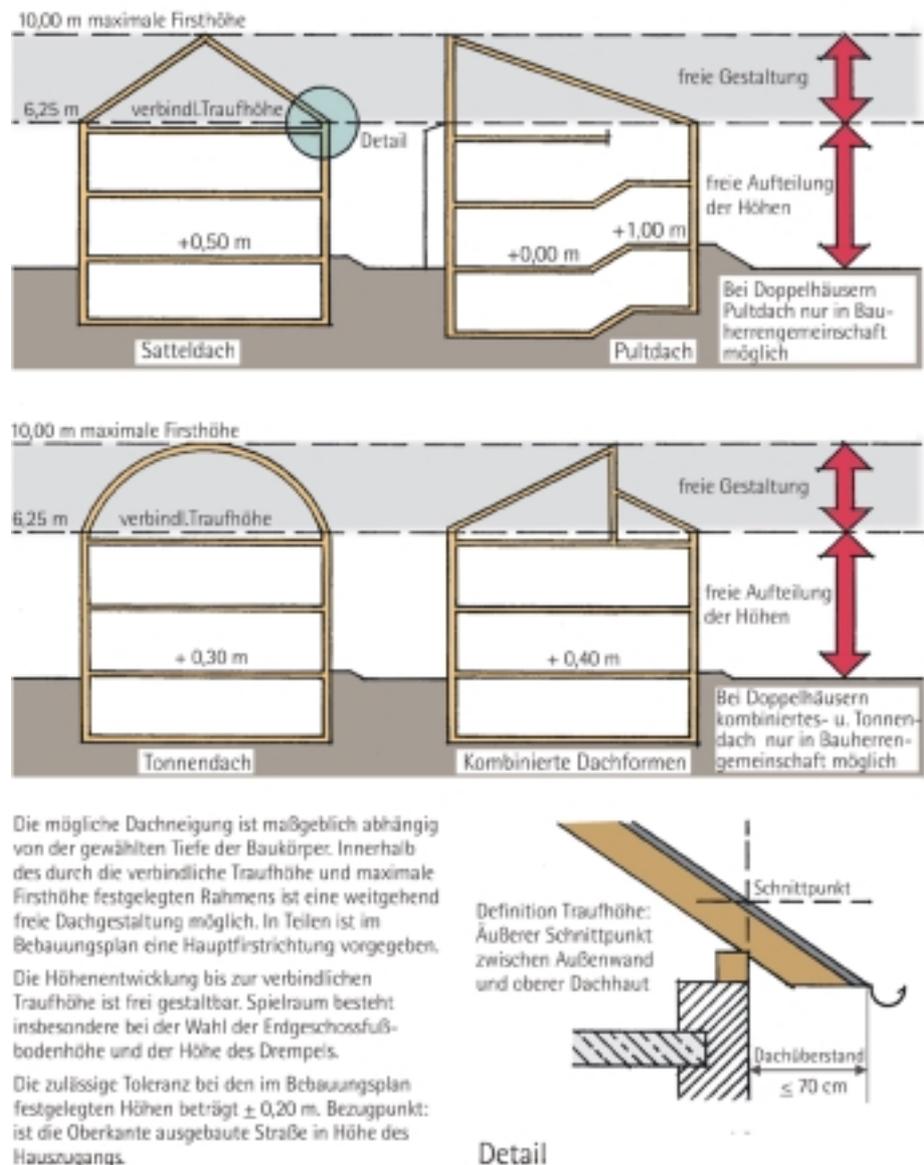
Beispiele für mögliche Dachgestaltungen bei zweigeschossiger Bebauung
